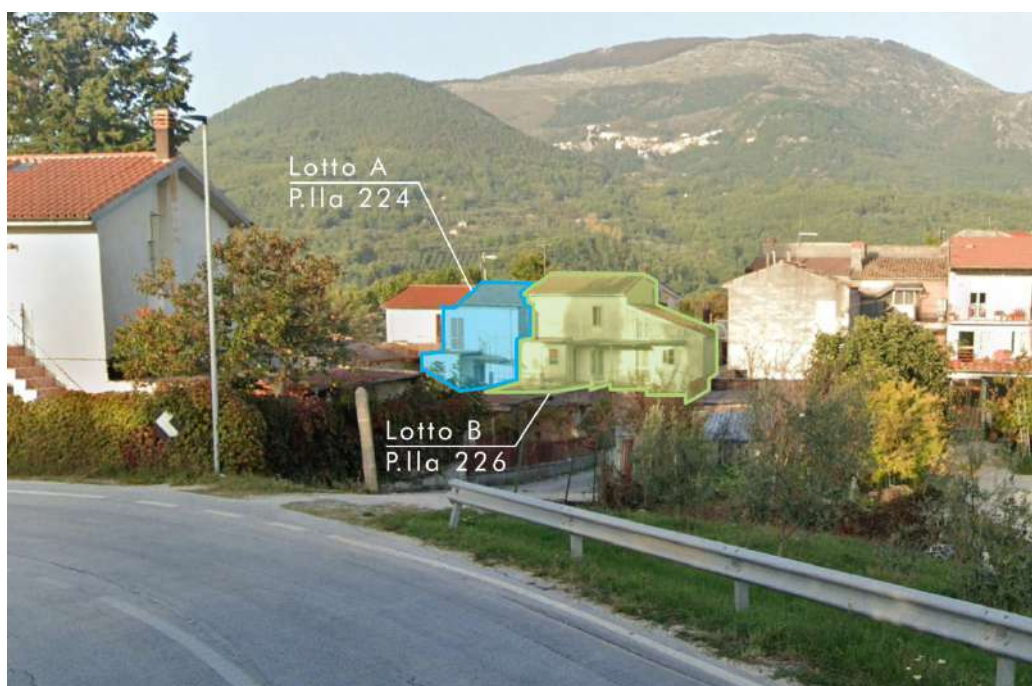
Vista del prospetto sud-ovest dell'aggregato con individuazione delle unità abitative oggetto di pignoramento.
